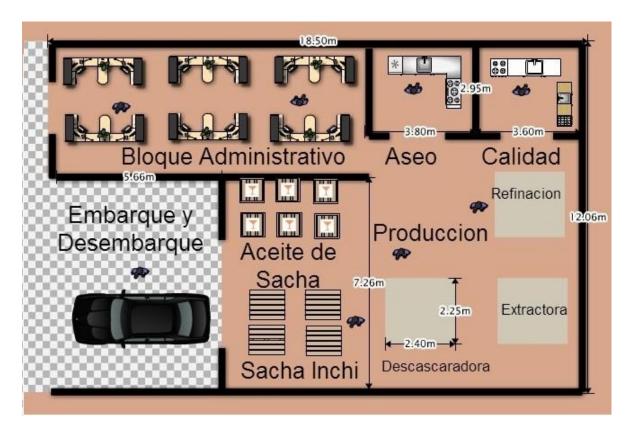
Distribución de la planta. Fuente: elaboración propia.
